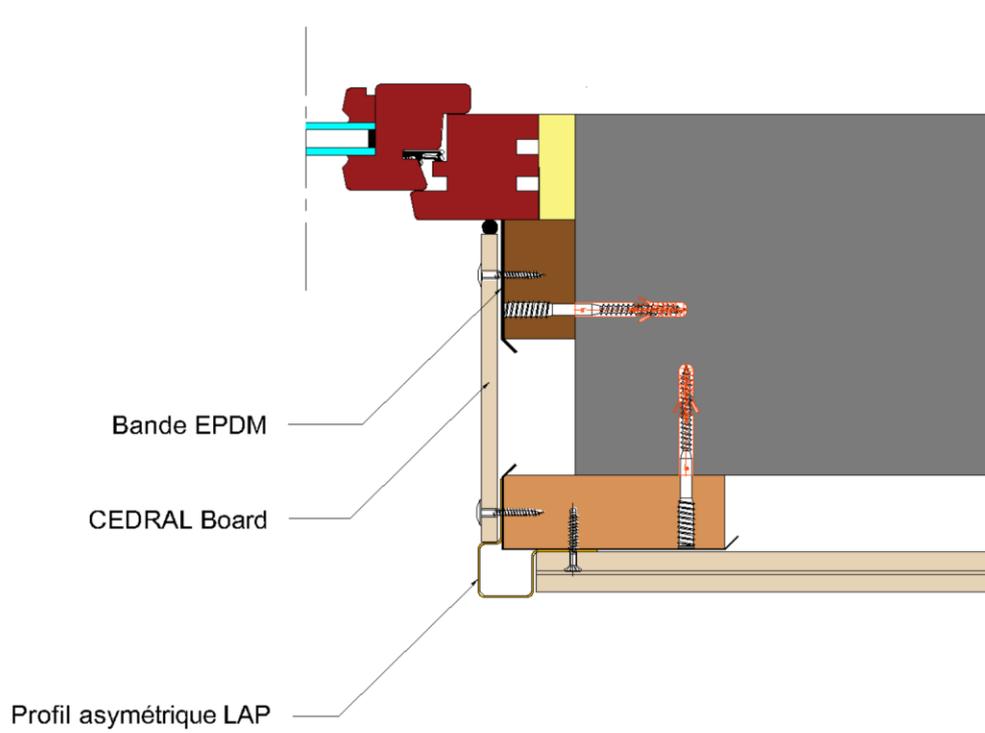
Encadrement de fenêtre coupe sur tableau – pose horizontale des lames CEDRAL LAP avec panneau CEDRAL BOARD en finition
